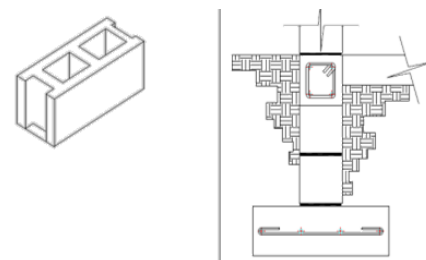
Mampostería y cimentación de concreto armado. Gráfica propia (2015)
